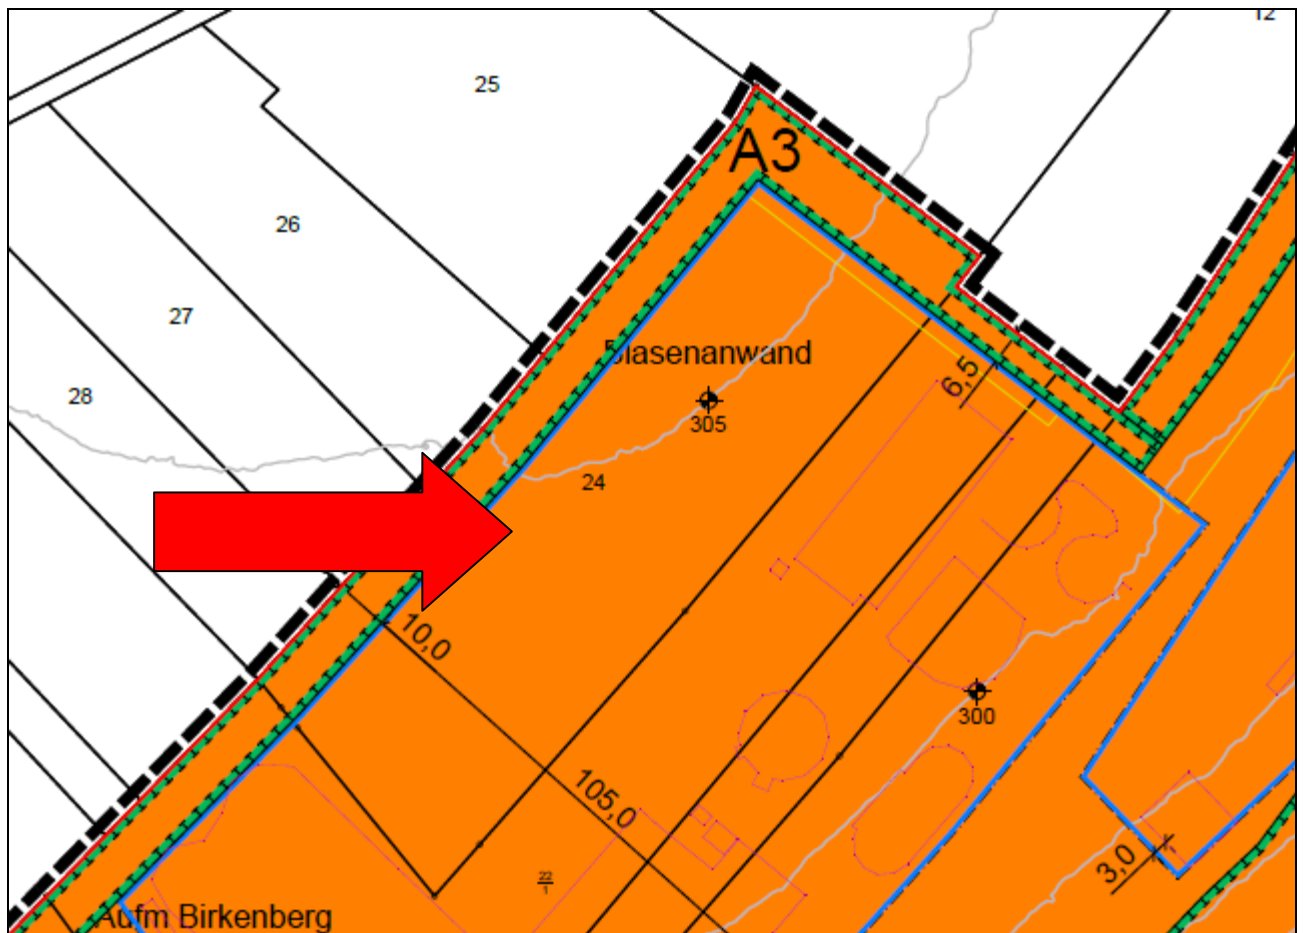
Auszug Bebauungsplan 2. Änderung (ISU 2019)
